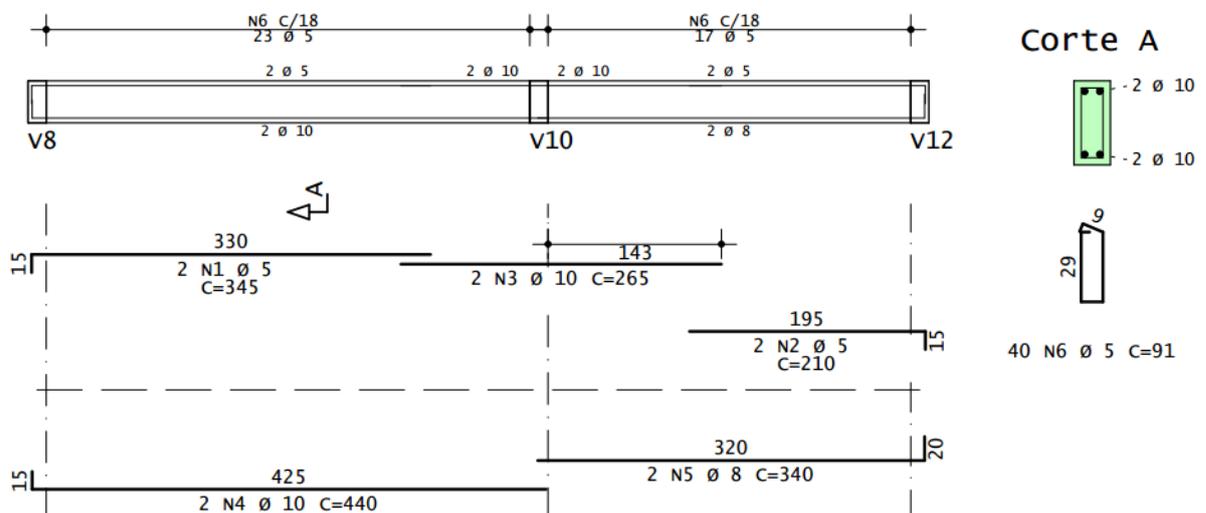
Armadura da viga baldrame V7 – pavimento térreo (nível 0,00)
